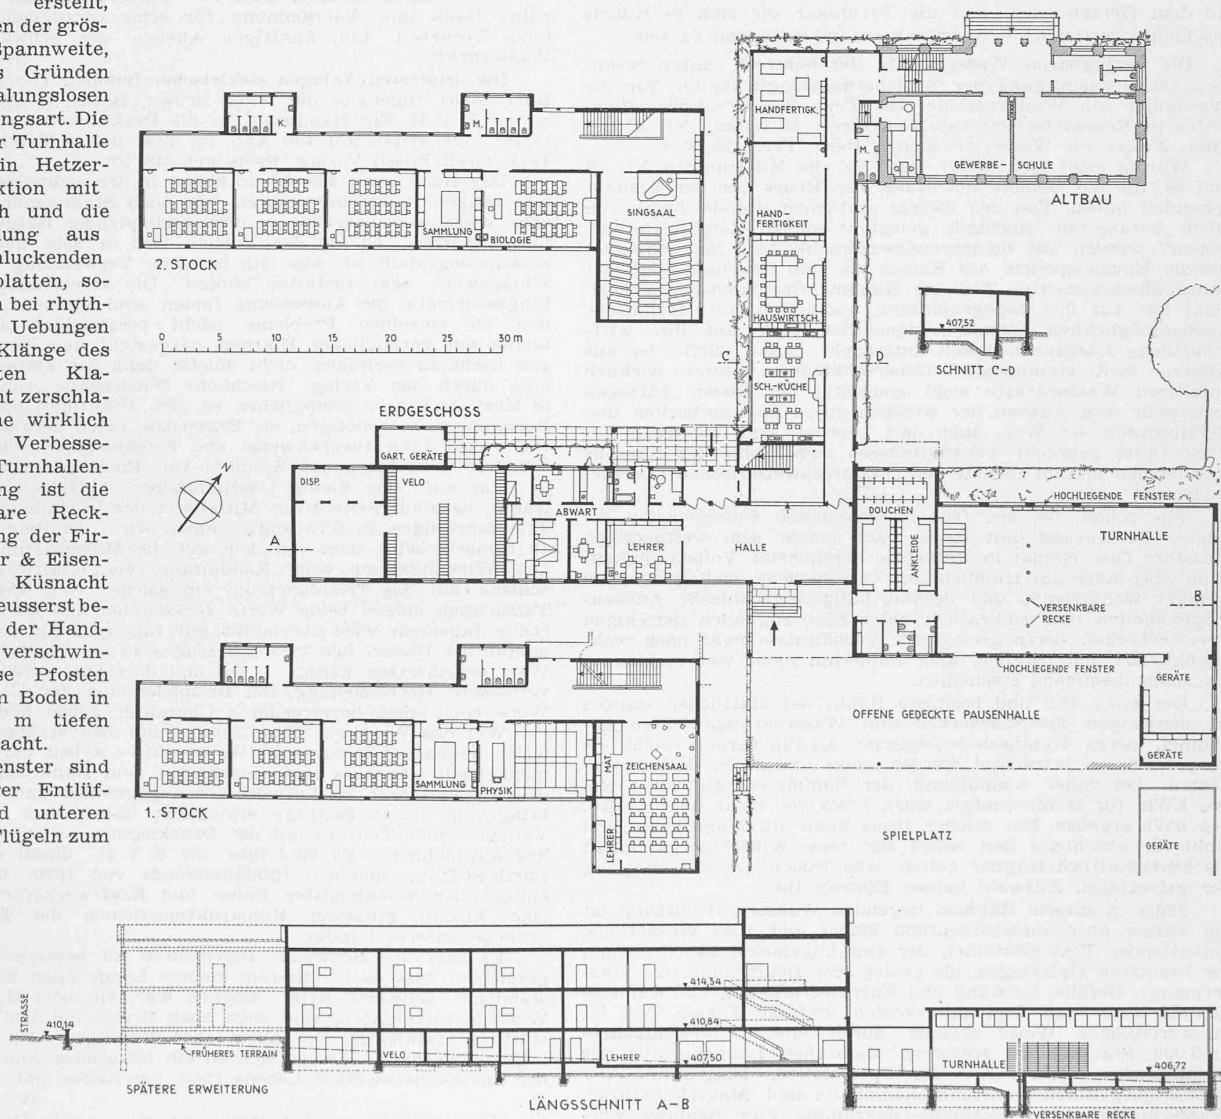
und 6. Sekundarschulhaus Kreuzlingen, Arch. H. A. SCHELLENBERG. — Grundrisse und Schnitte 1: 600
